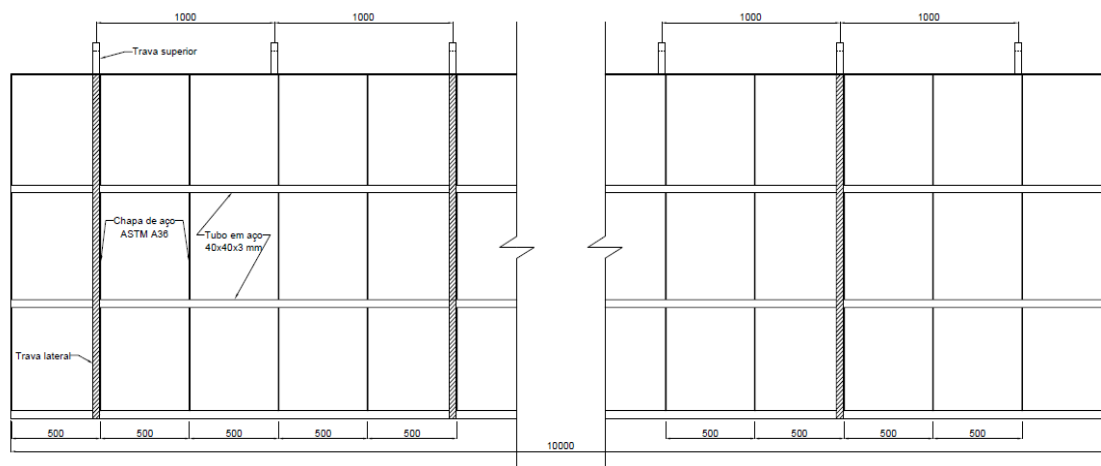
Vista transversal de uma seção de referência de fôrma metálica de viga de concreto pré-moldada para OAE
